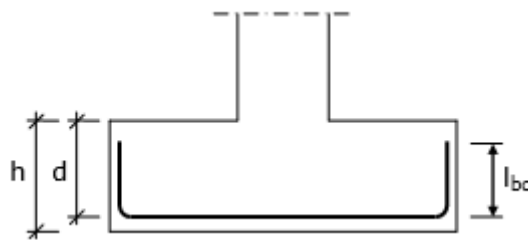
Amarração da armadura principal em sapatas. (Félix, 2014)
